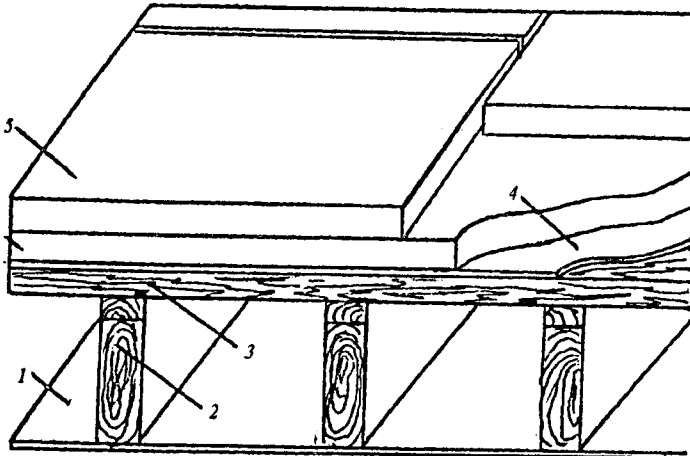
Зовнішнє утеплення плоского даху: 1 – стеля; 2 – брус несучої конструкції; 3 – дерев'яна панель; 4 – гідроізоляційне покриття; 5 – теплоізоляційний шар; 6 – тротуарна плитка.
